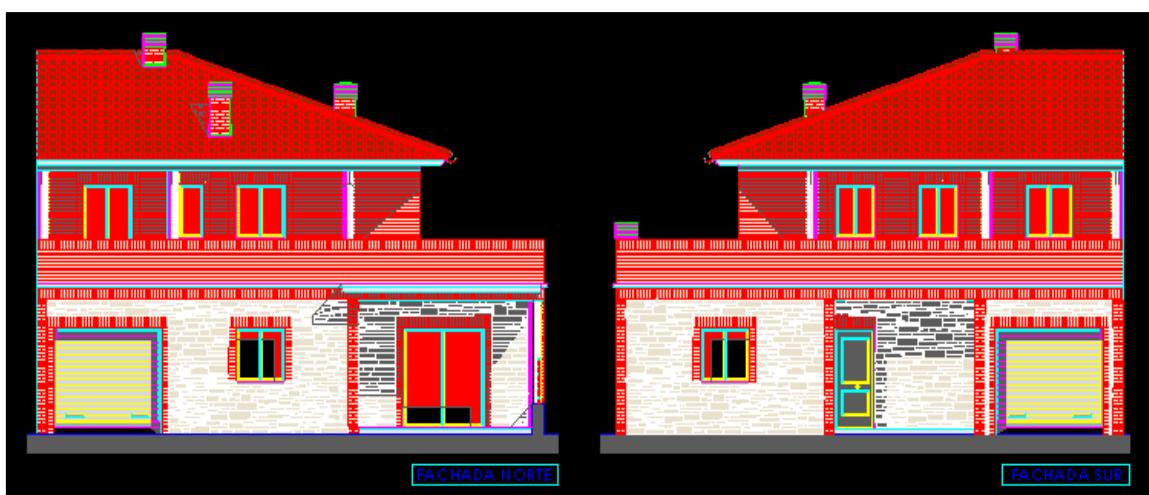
Fachada Norte y fachada Sur de la vivienda Objeto
